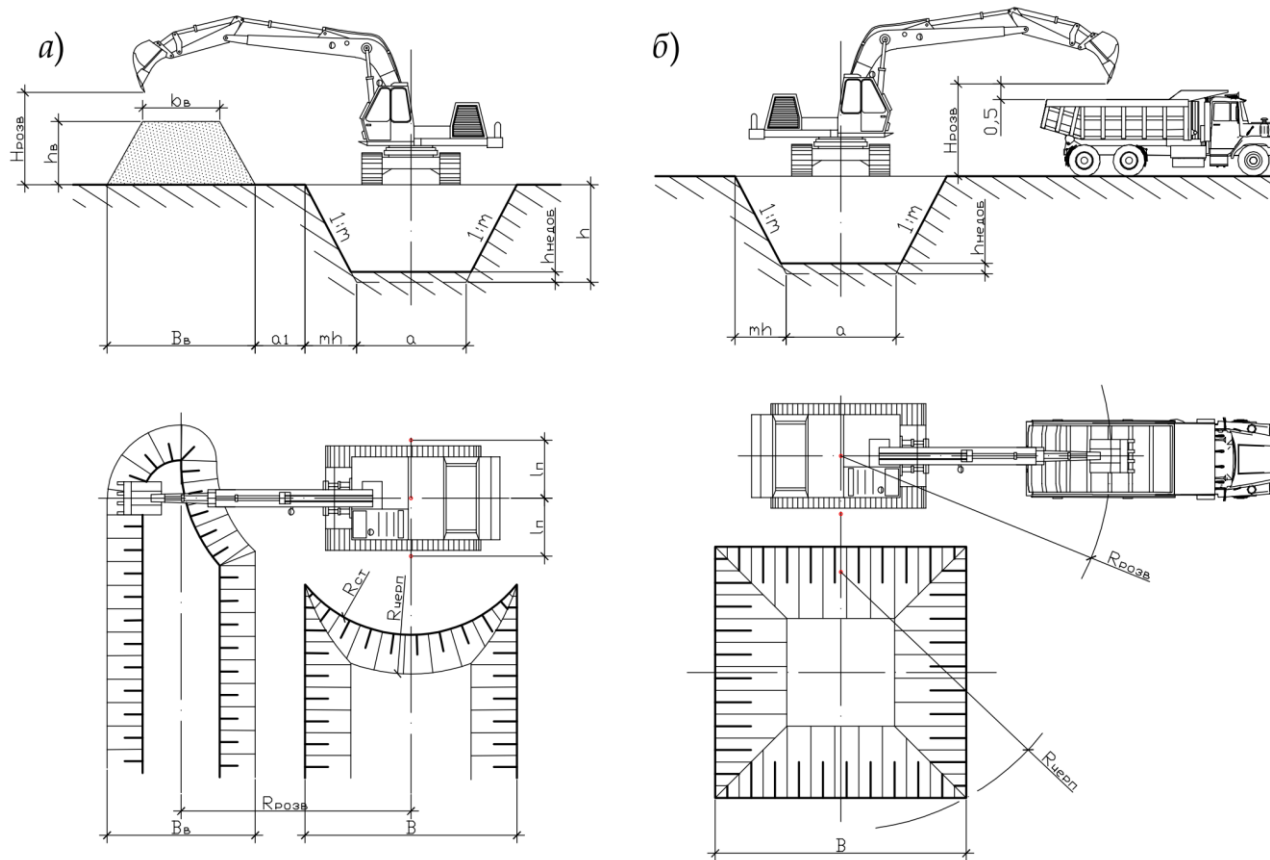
Схема заборів для екскаватора обратная лопата: a_j — расстояние от бровки выемки до отвала грунта; b_0 — ширина отвала поверху; h_0 — высота отвала; b_0 — ширина отвала понизу (остальные условные обозначения см. в подрисовочной подписи к рис. 18)
